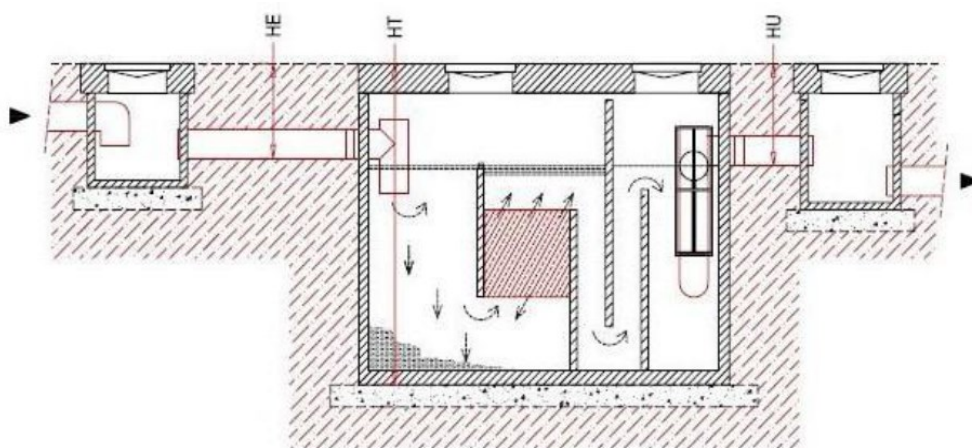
Sezione impianto di trattamento acque di seconda pioggia
